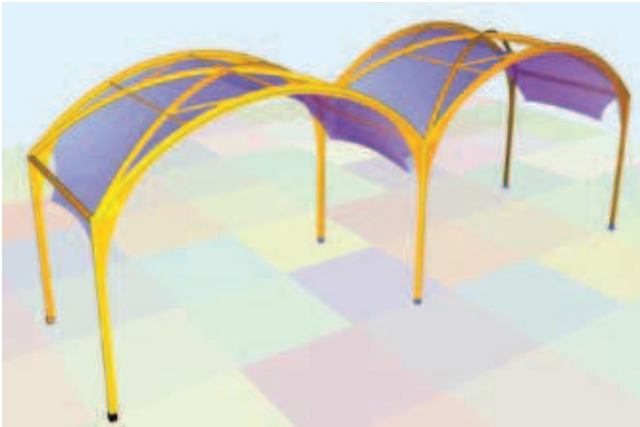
Nowe możliwości kształtowania konstrukcji – nad widownią amfiteatru wykonano dach składany (amfiteatr w Kadzielni)
